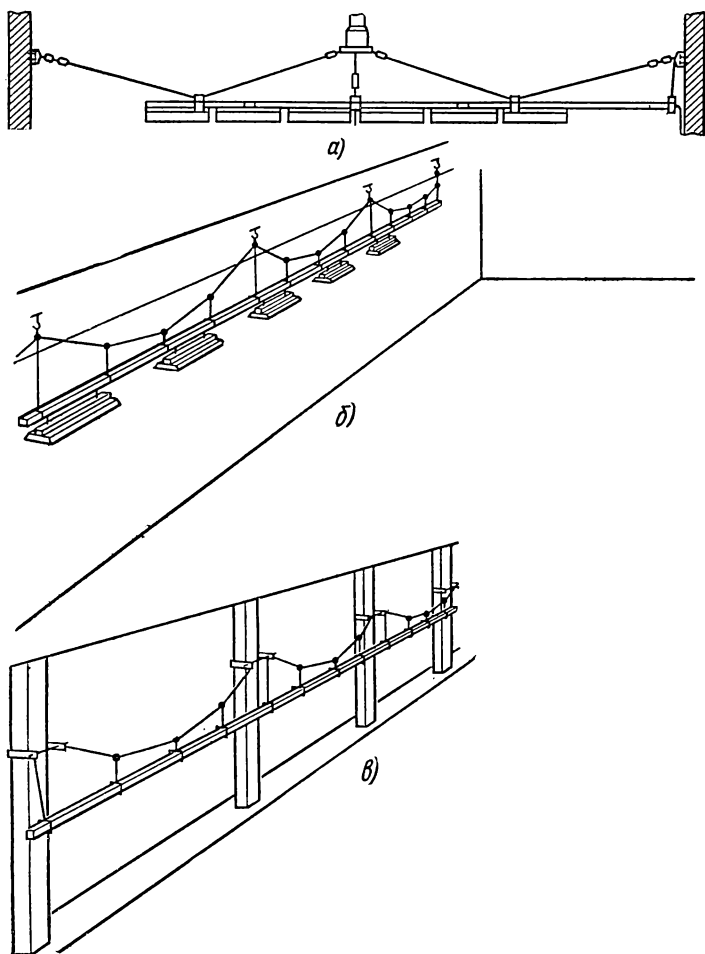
Монтаж осветительных (а, б) и силовых (в) электропроводок в стальных коробах.
